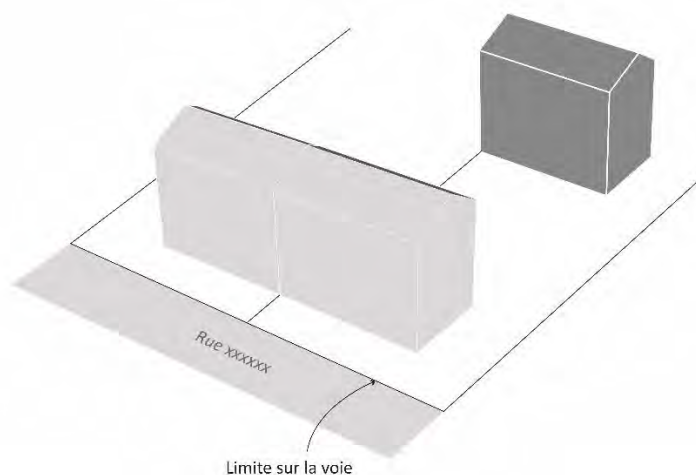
\_ Implantation en retrait par rapport à la voie, présence d'une construction principale à l'avant
